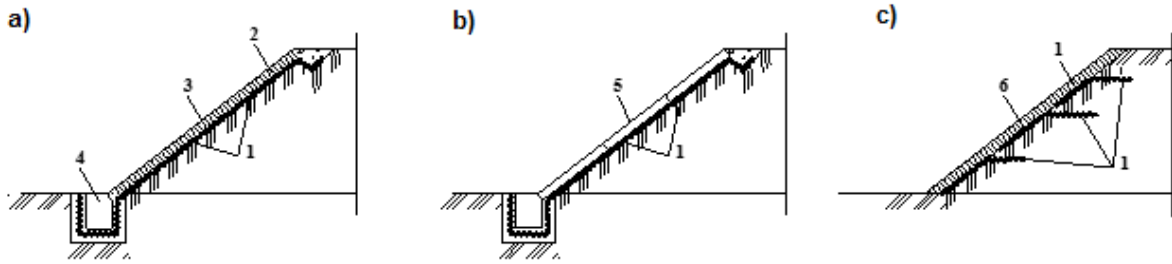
Укрепление откосов земляного полотна ГМ в комбинации с решетчатыми конструкциями (а), бетонными плитами (b) и укрепление армированием поверхностной зоны (с)
